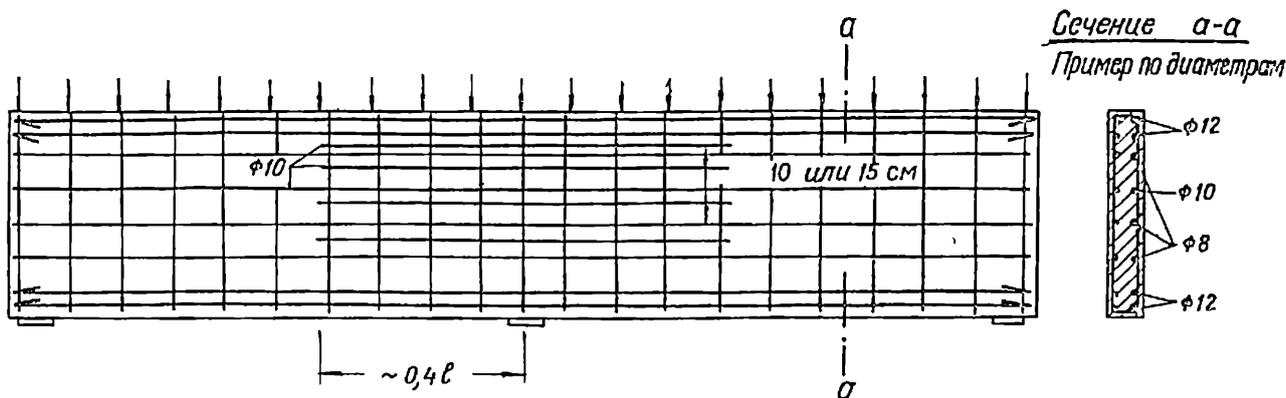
7. Армирование многопролетной балки-стенки ($l/h = 2,5$)
